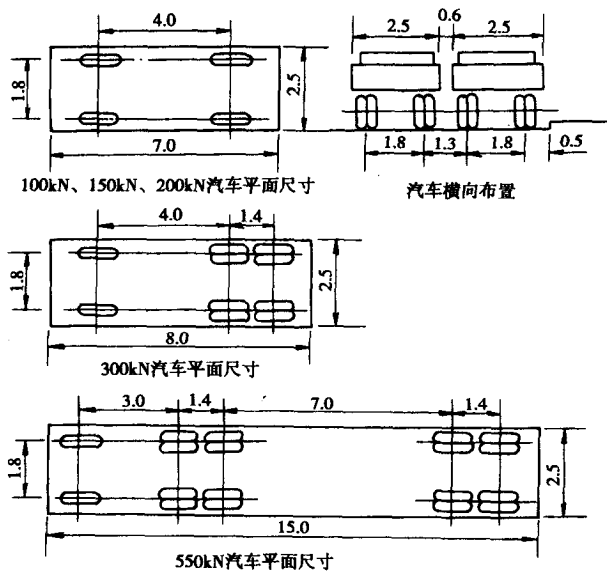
各级汽车的平面尺寸和横向布置 (尺寸单位 : m)
